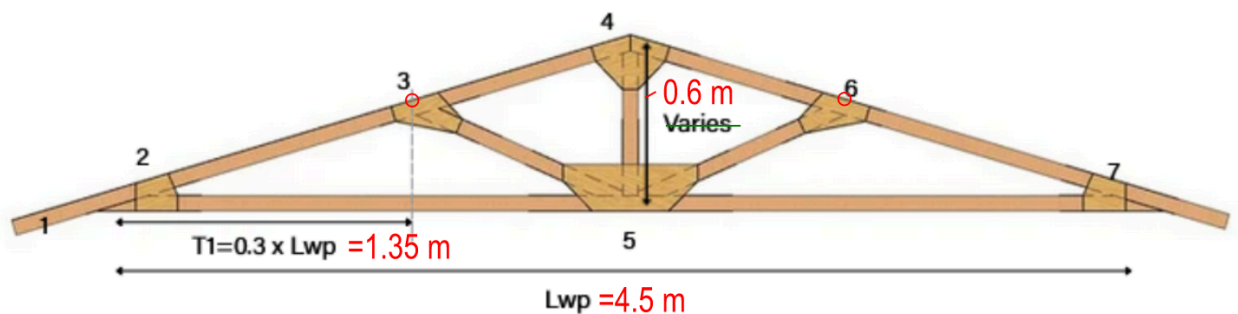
Extrait de la figure 1.5.6.9.9-5
